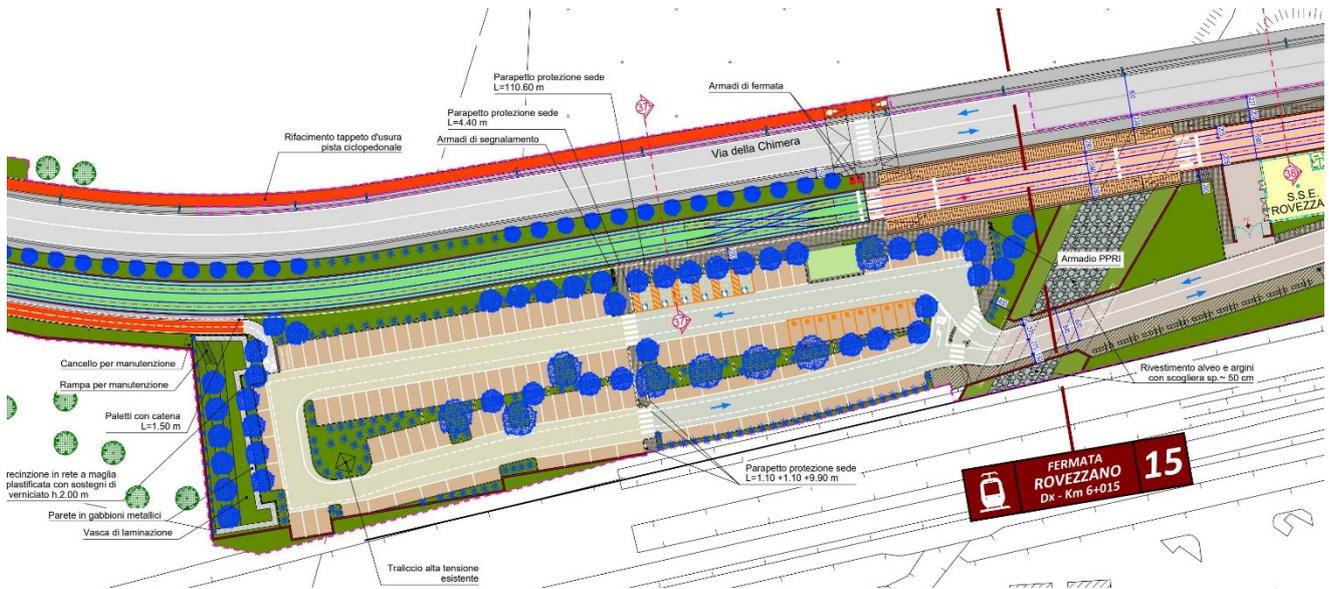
Planimetria di progetto dell'area del parcheggio scambiatore di Rovezzano
